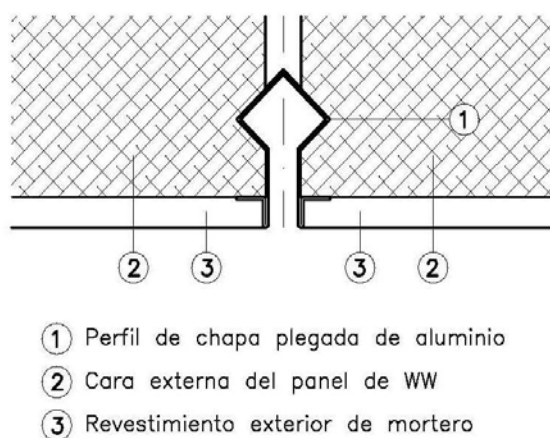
esquema de junta entre paneles de fachada de tamaño grande
